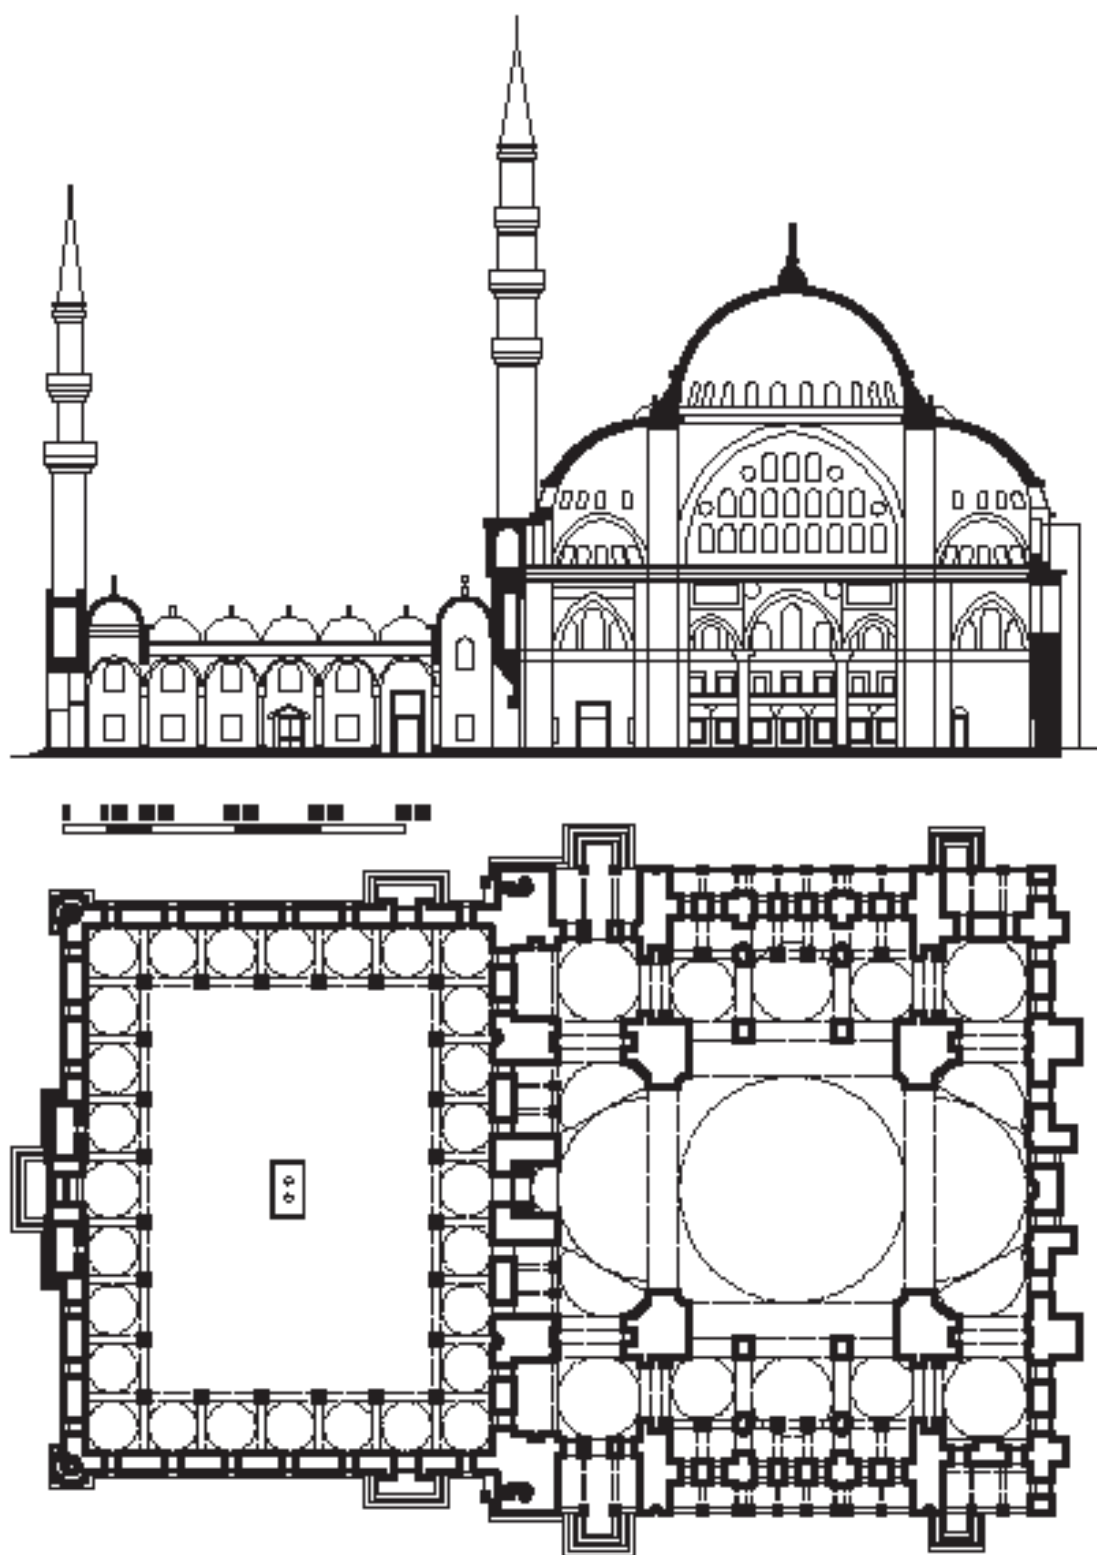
Mezquita de Süleyman. Planta y sección longitudinal. (Dibujo del autor).
